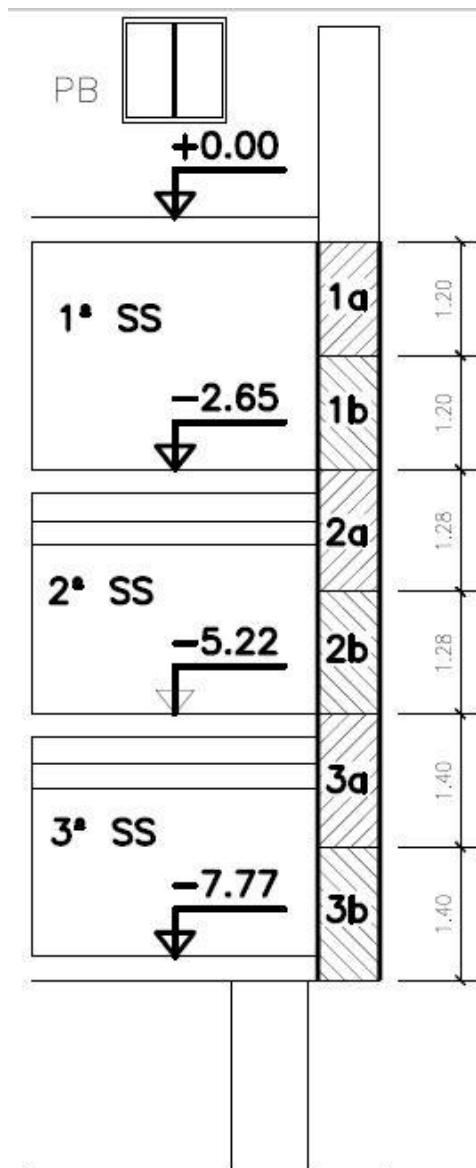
Esquema de construcción de tabiques de sumeduración
